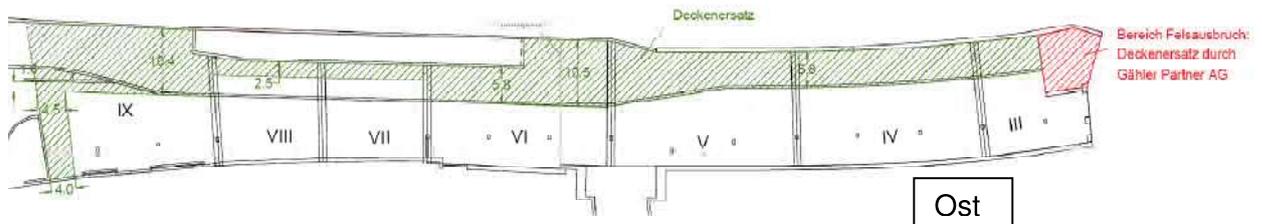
Deckenersatz Tunnelgarage gemäss Auflageprojekt Neubau Schulhausplatz
